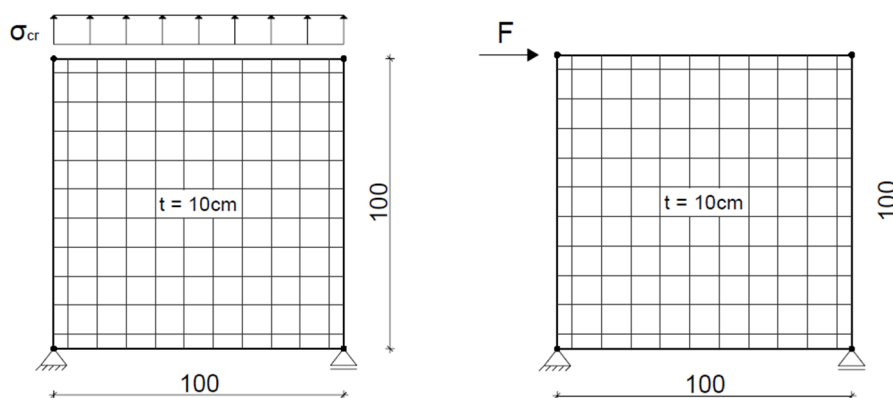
Statisches System und Lastfälle der bewehrten Betonscheiben aus [59]
